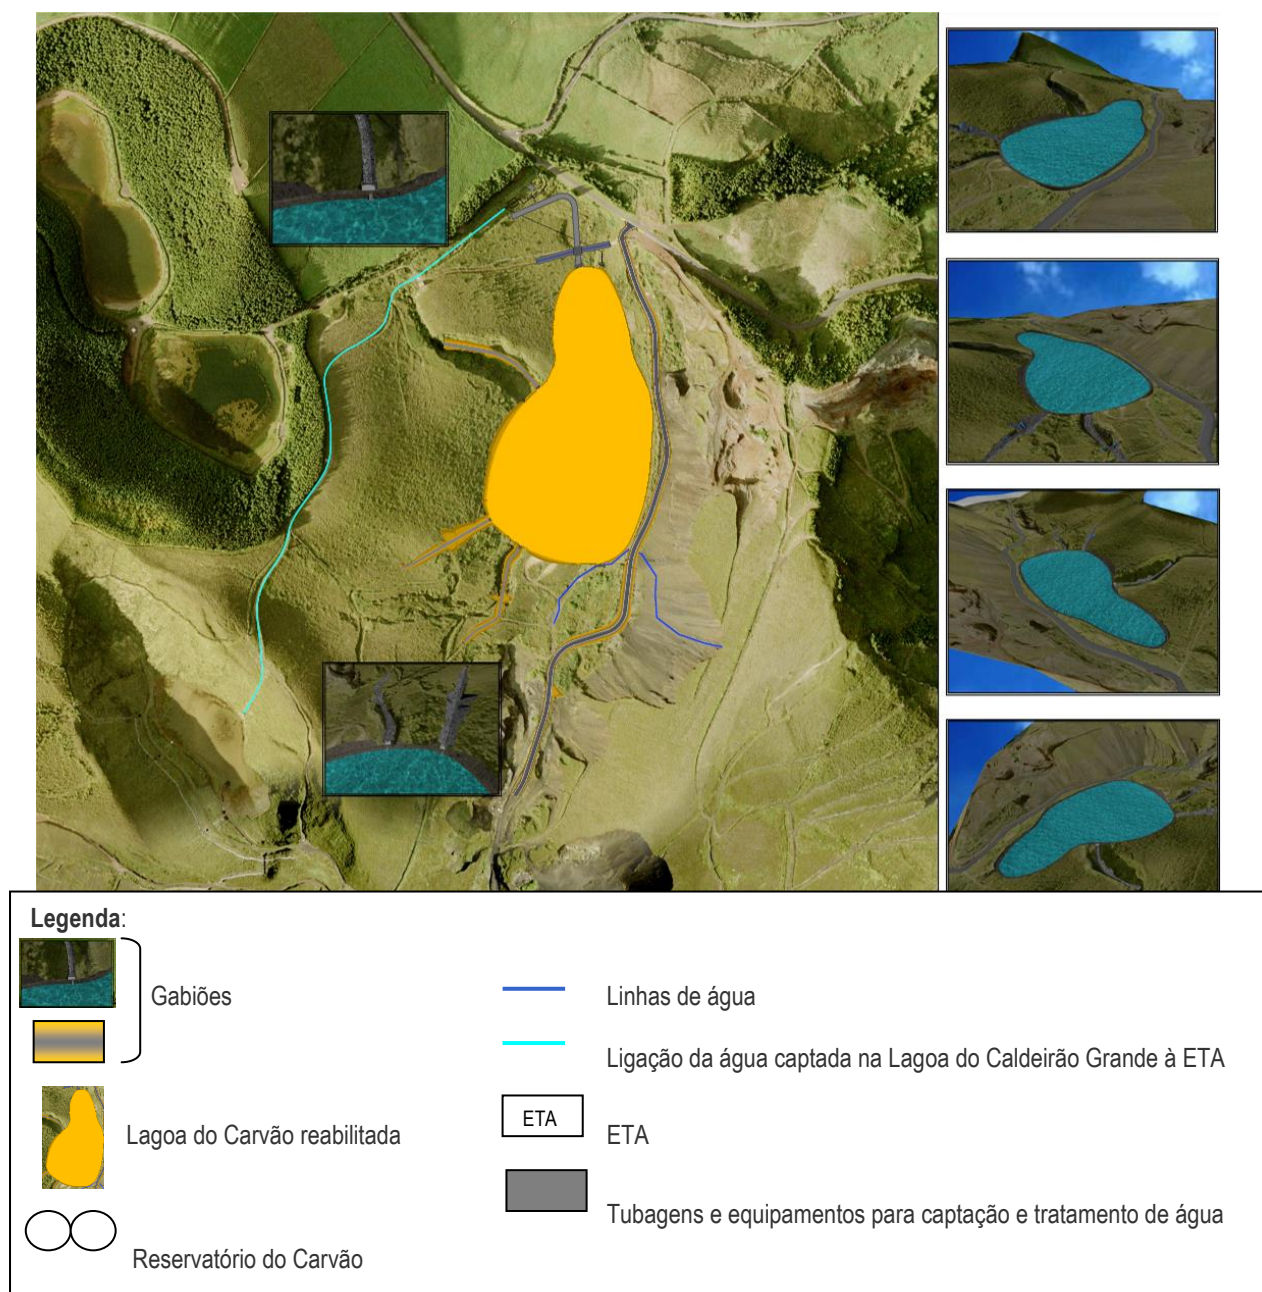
| Planta Geral do projeto de Reabilitação da Lagoa do Carvão (Estudo Prévio).
